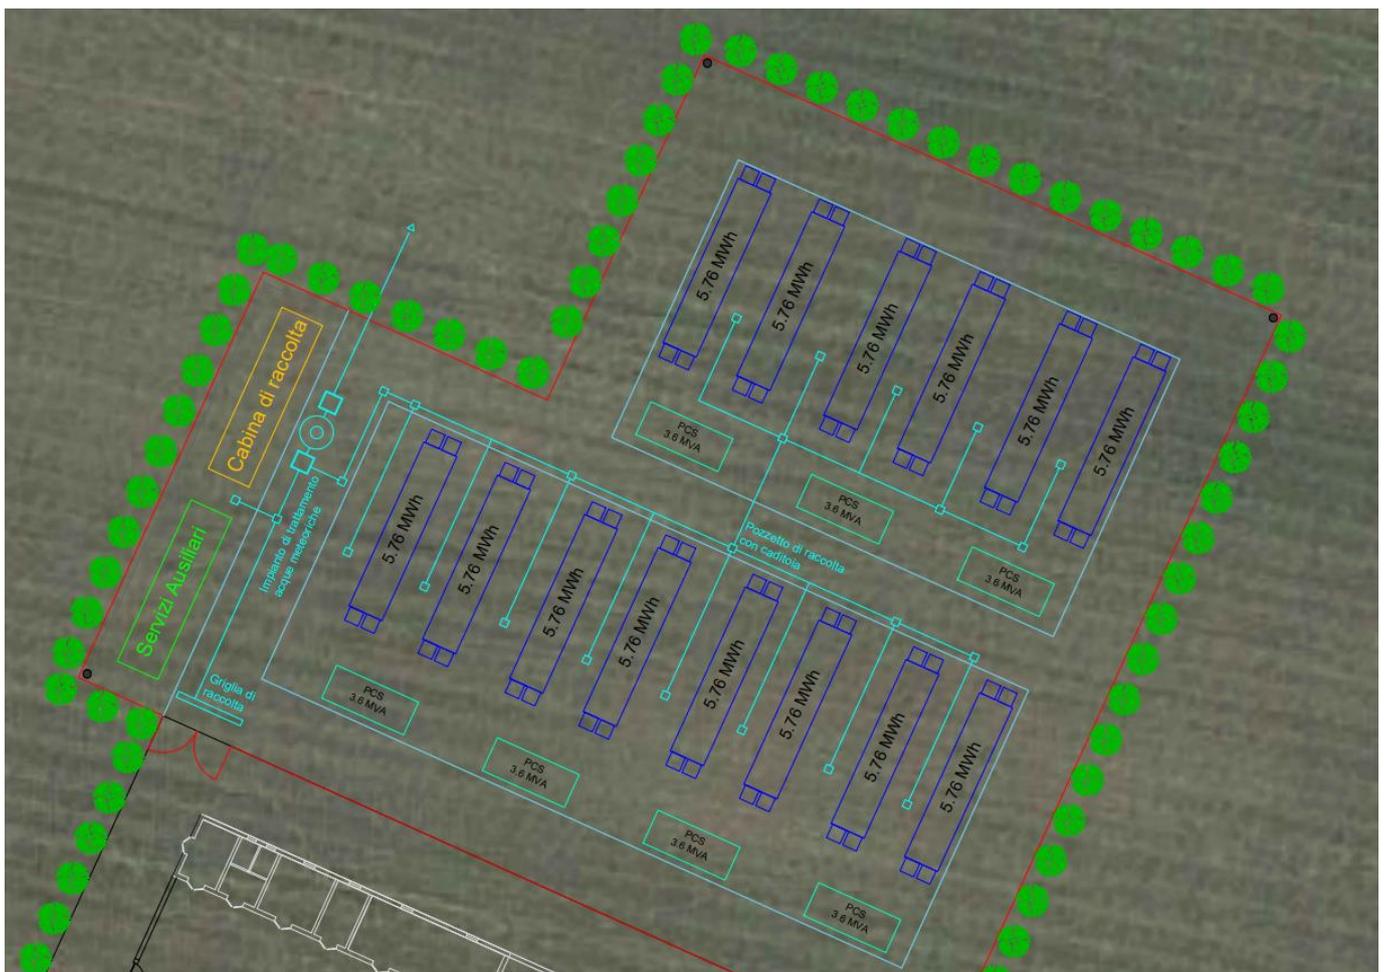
Planimetria del sistema di accumulo con indicazione della rete di drenaggio delle acque meteoriche
